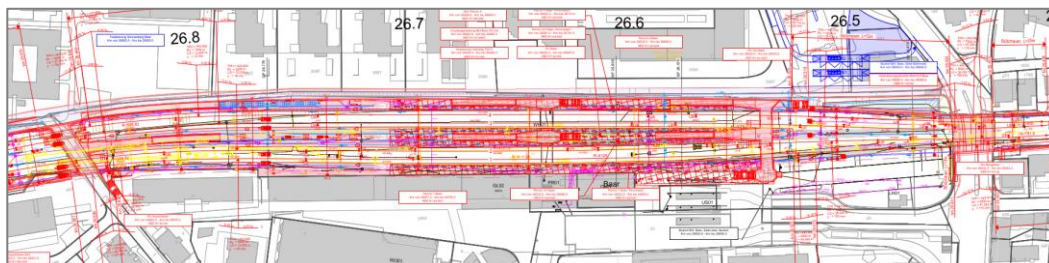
Ausschnitt Koordinationsplan STEP AS 2034 BHF Baar
